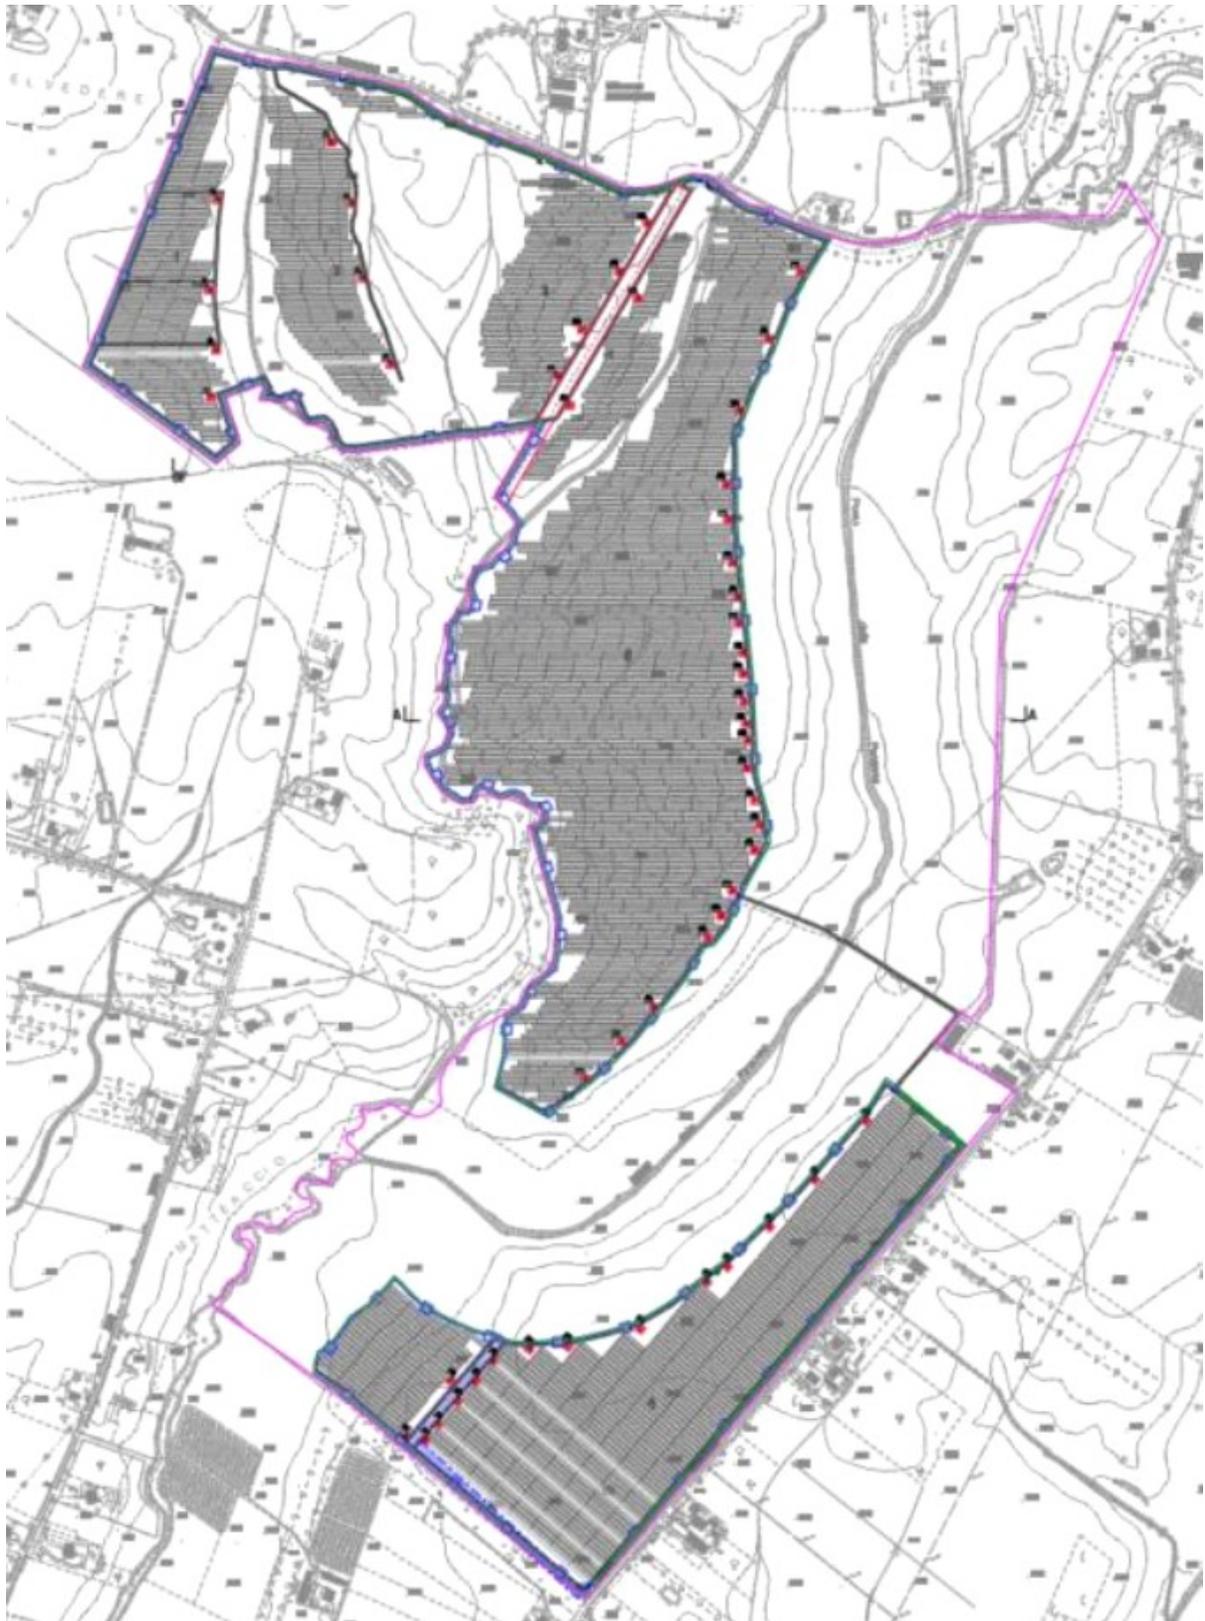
planimetria generale dell'impianto fotovoltaico
